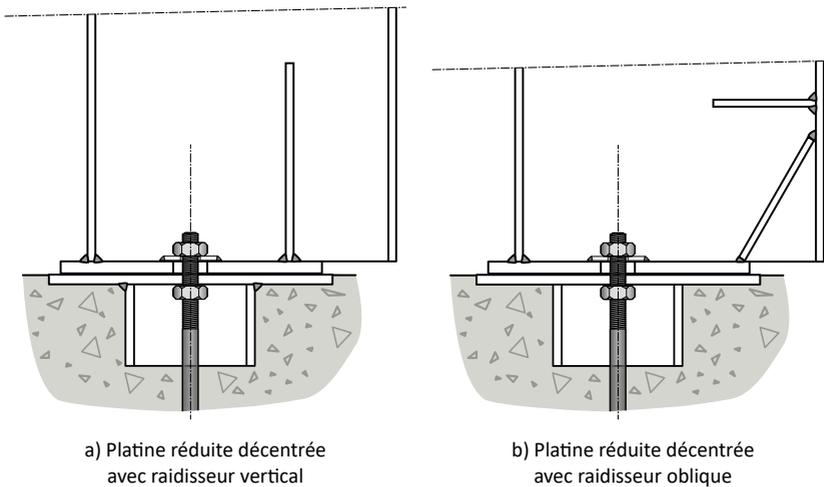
Pieds de poteaux articulés avec platine réduite décentrée
